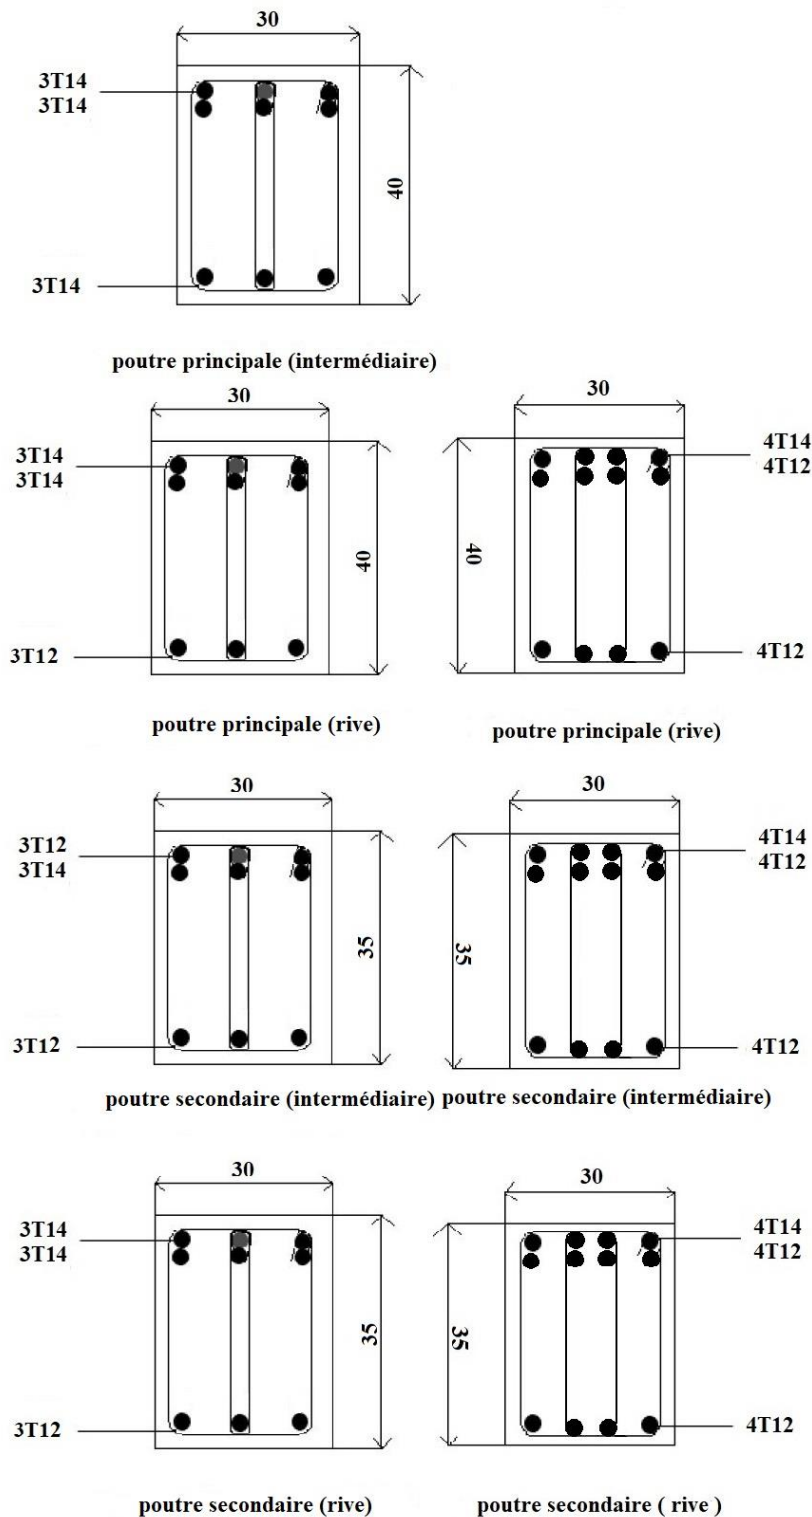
Disposition du ferrailage des poutres (Terrasse et étages).
